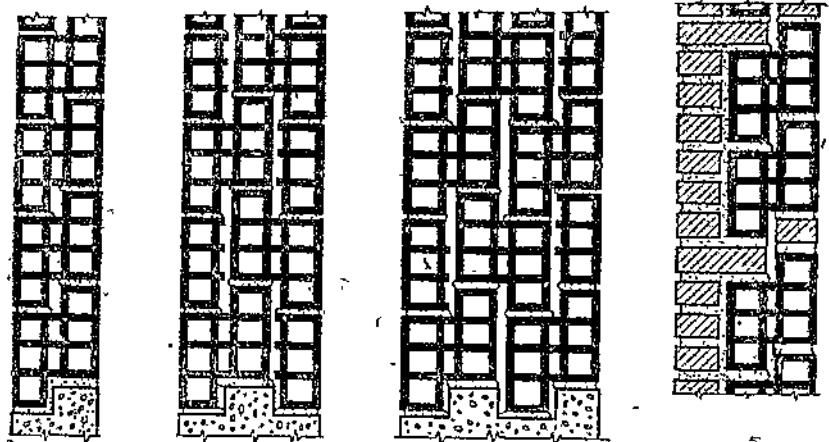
Кладка стен различной толщины из „универсальных“ блоков.
